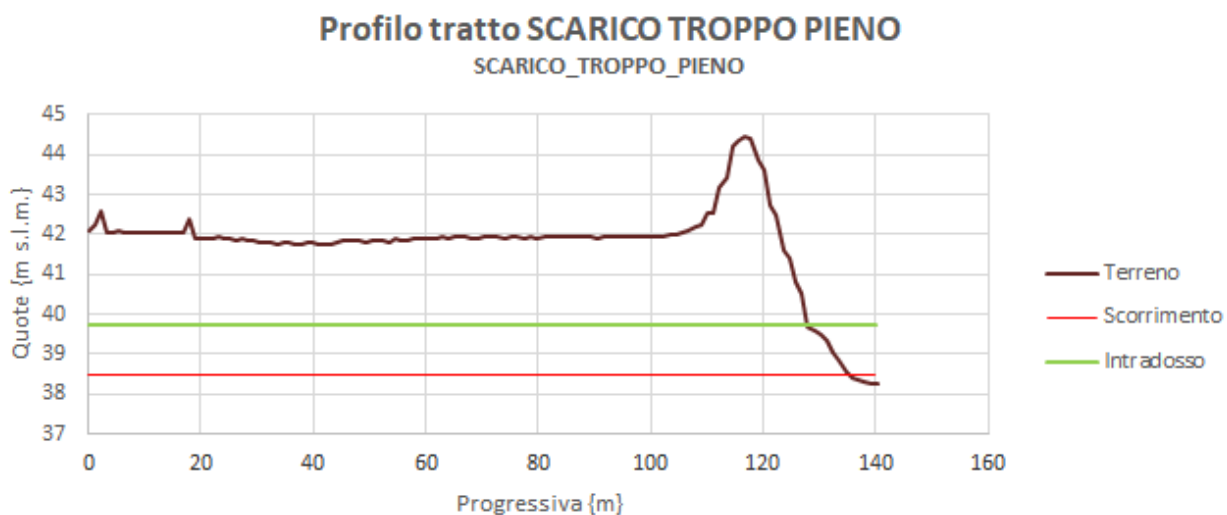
Profilo longitudinale SCARICO TROPPO PIENO
